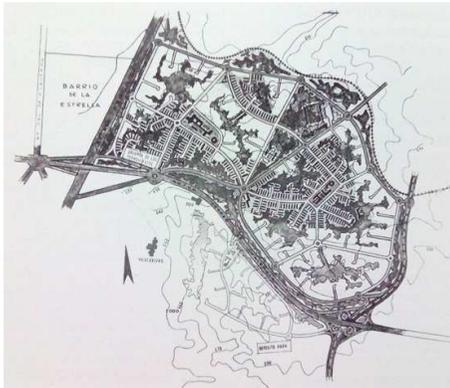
y 116. Barrio de Moratalaz, bajo el régimen de vivienda subvencionada. Planta de ordenación del sector e Imagen general. Madrid, 1960. Arq. R. de la Joya (Ordenación) y J.A. Domínguez Salazar (Viviendas).
